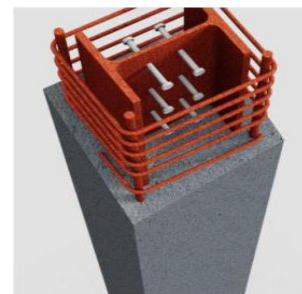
poteau a structure mixte en « I ».⁸⁴
